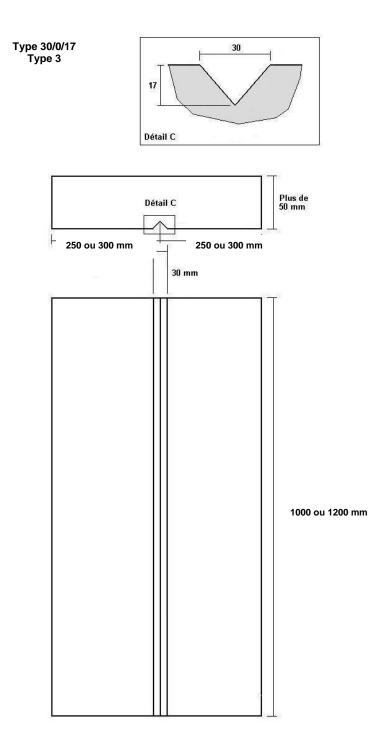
Panneaux à bossage Type 3 (dimensions en mm)
